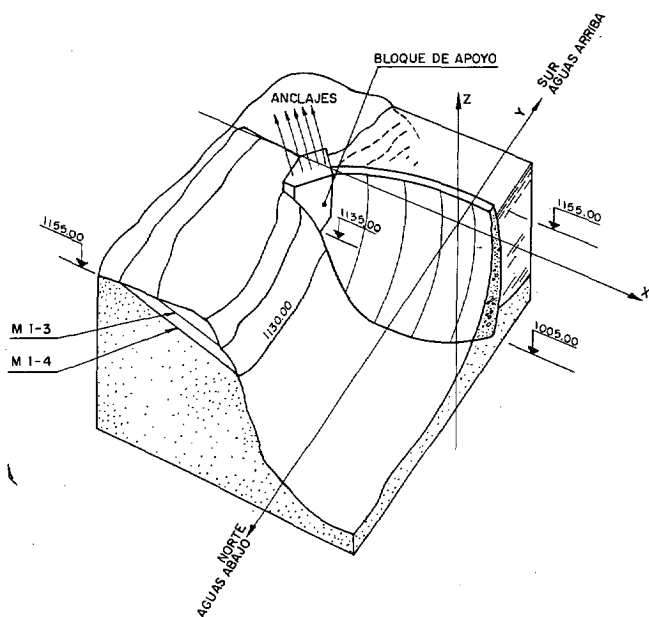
Presa de Turkwel. Estribo derecho. Vista general de la presa y bloque de apoyo
